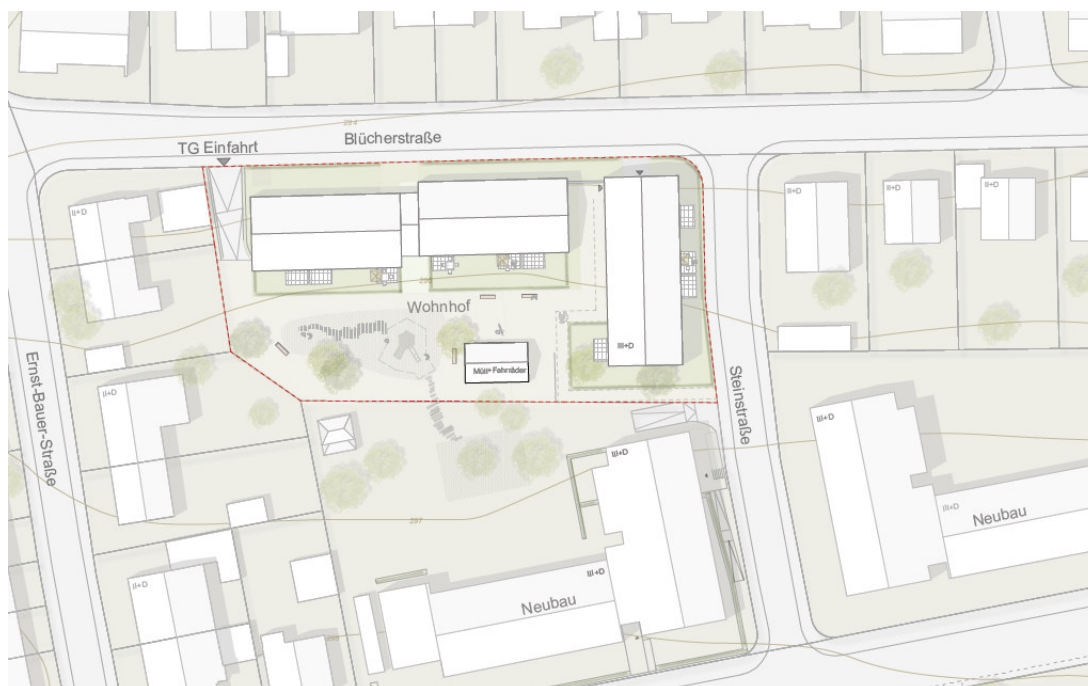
Lageplan Machbarkeitsstudie Stand 22.01.2019 (Quelle: Project GmbH)
